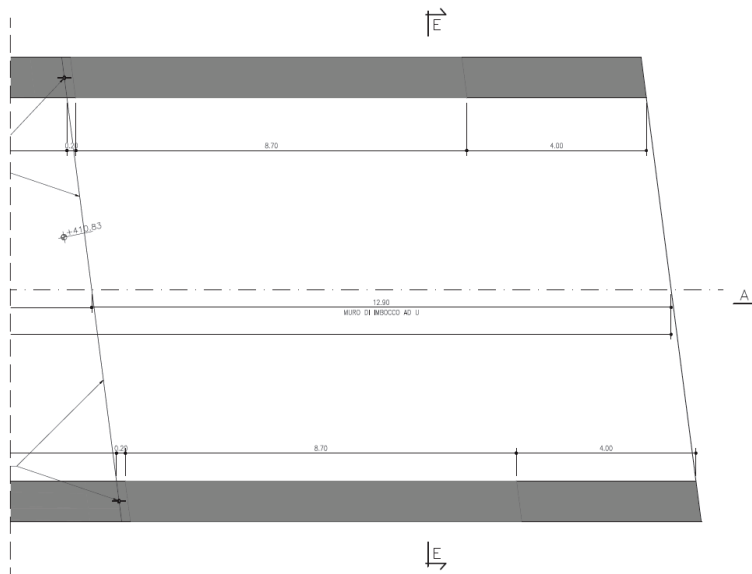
Muri d'imbocco - Pianta inferiore
